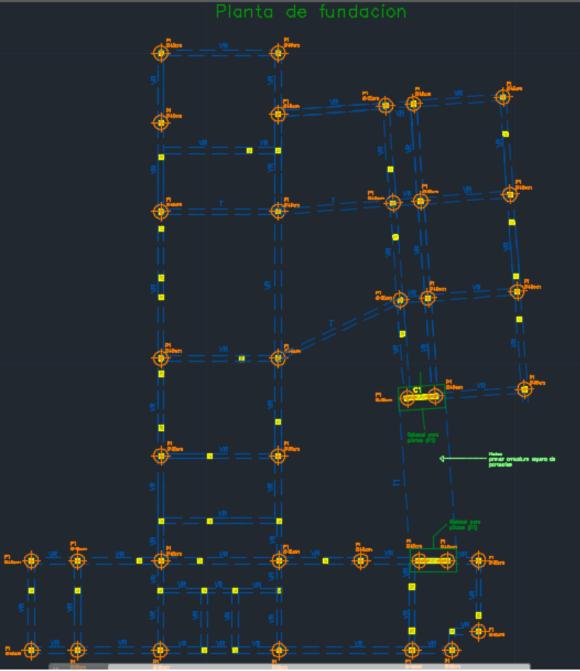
Planta de fundación con ubicación de pozos para pilotes
